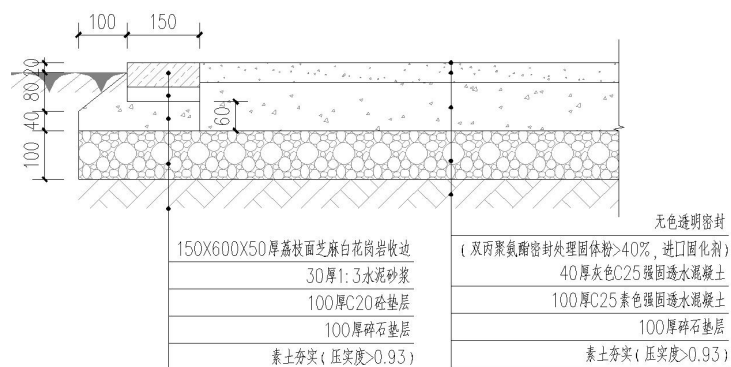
人行巡查便道（透水混凝土）路面结构
